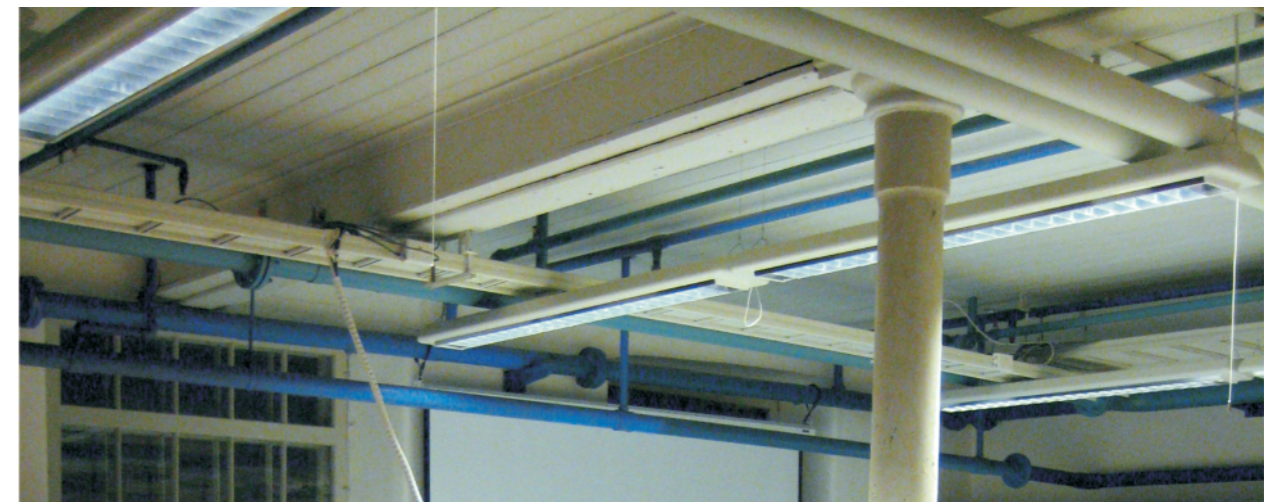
Sprinklersystemet på Kuusvooninkinen.
